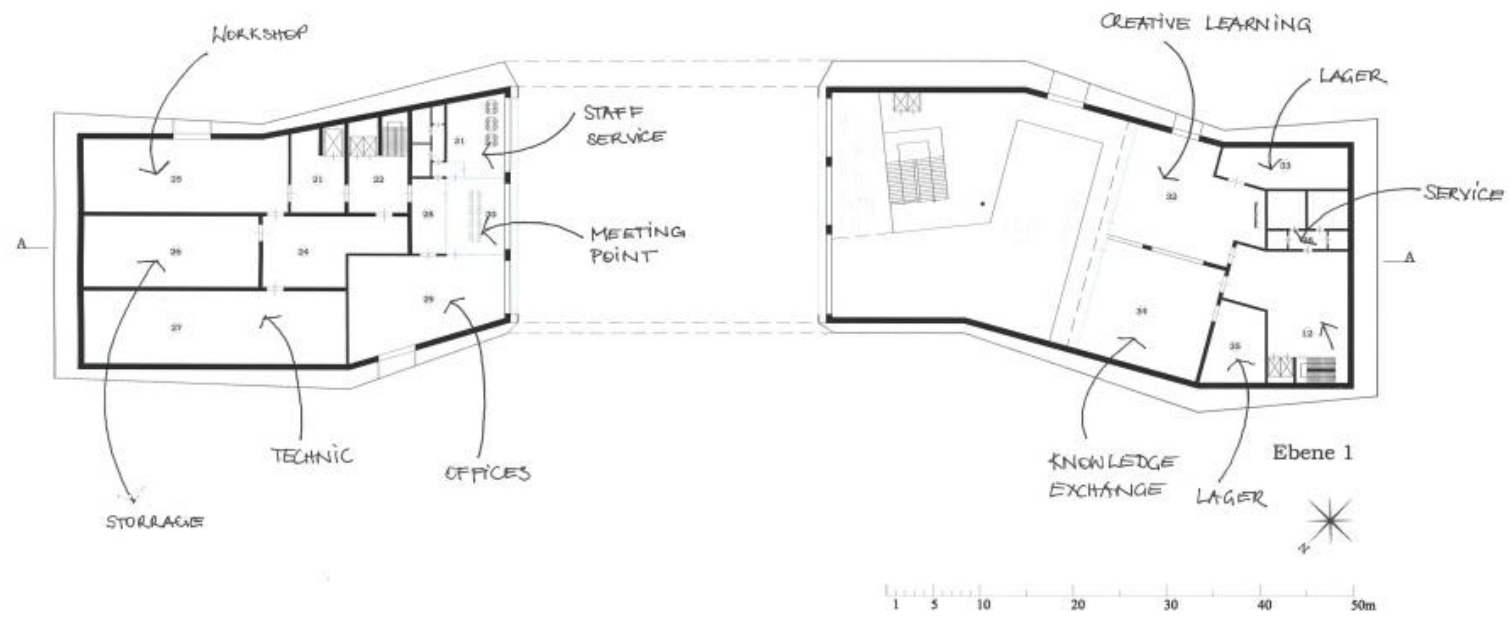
Übersicht Grundriss Ebene 1
